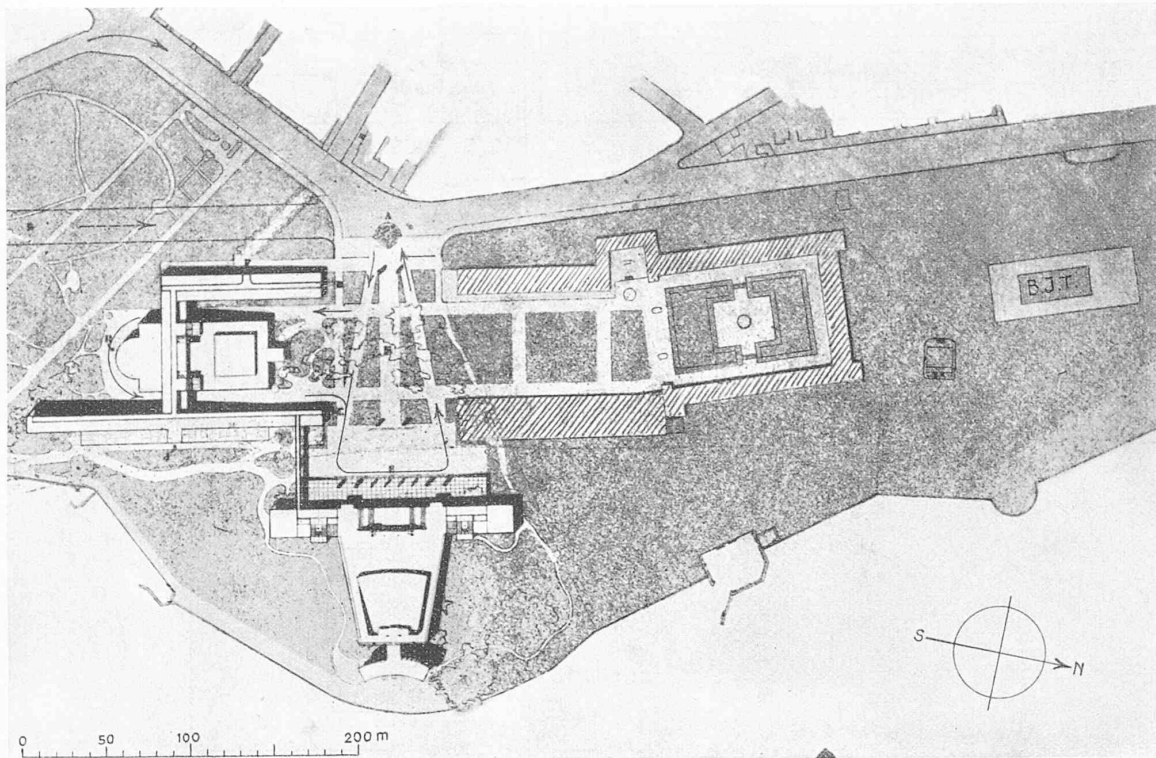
Situationsplan der Gesamtanlage, schraffiert spätere Erweiterung, rechts das bestehende B. I. T.-Gebäude. — Masstab 1 : 4000.
